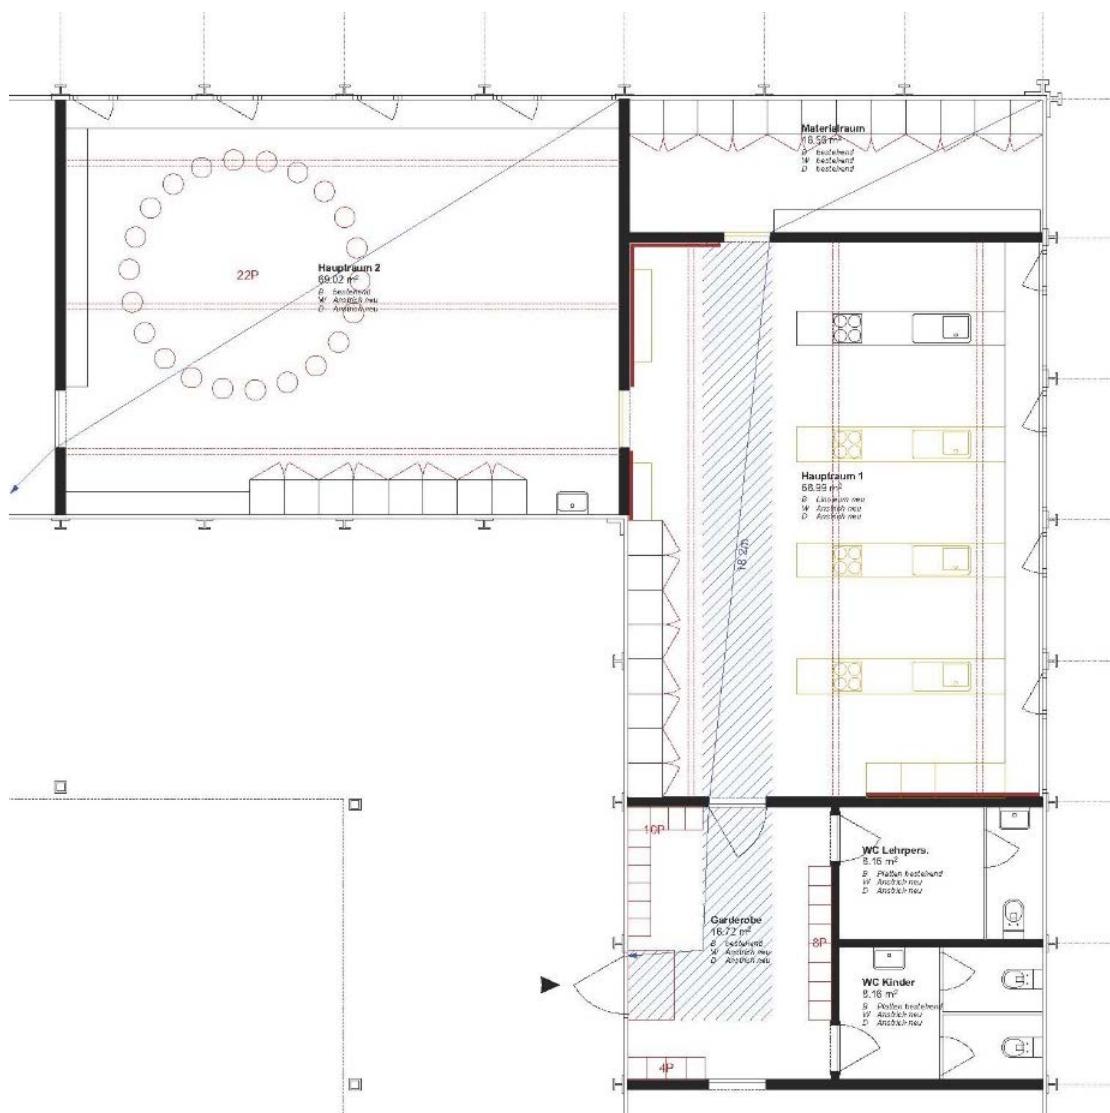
Grundriss L-Trakt (ohne Massstab)
